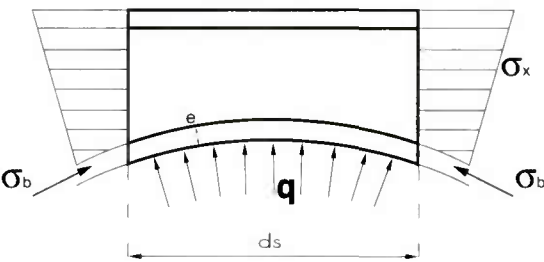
Poussée au vide d'un hourdis courbe - coupe longitudinale
